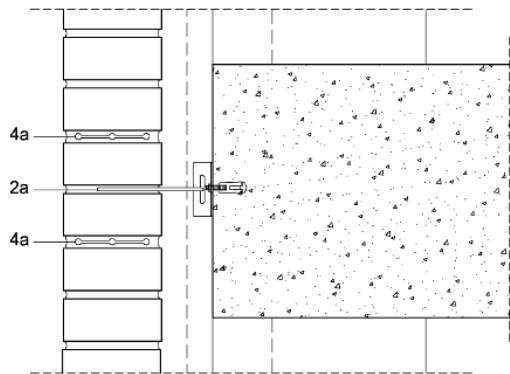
Sección vertical. Detalle de fijación de anclaje GEOANC® a forjado o pilar.
